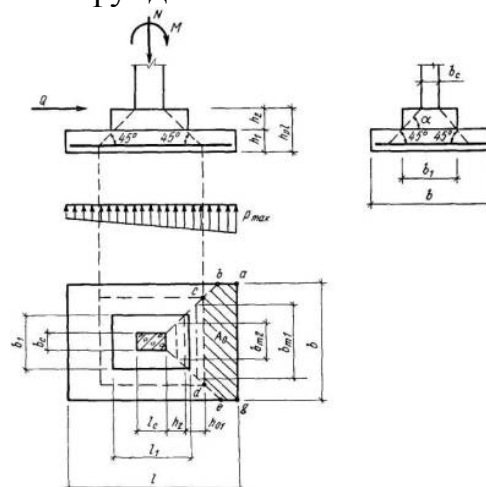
Схема образования пирамиды продавливания в центрально-нагруженных прямоугольных, а также внецентренно нагруженных квадратных и прямоугольных фундаментах.
